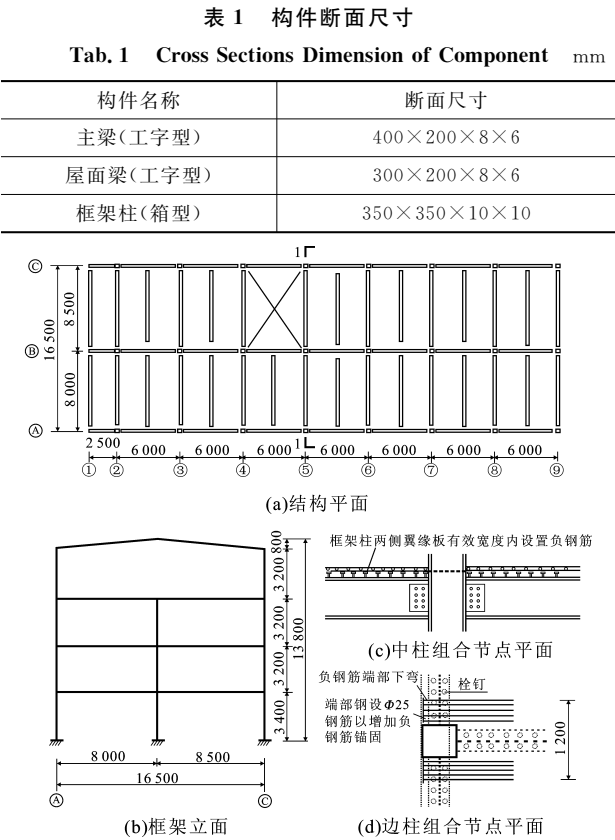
结构平面、框架立面和组合节点构造(单位:mm)
